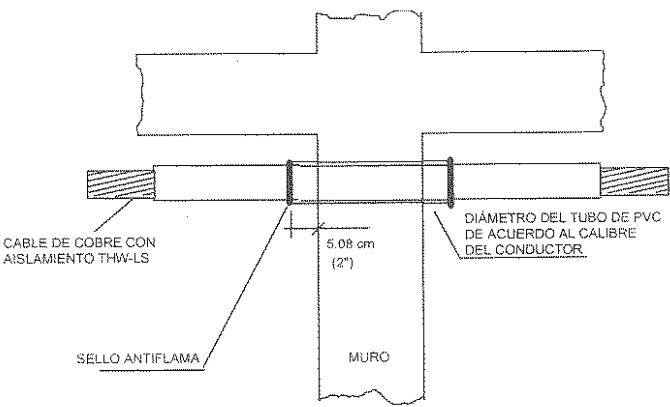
Paso del Cable por Muro Mediante Tubo Conduit de PVC.
